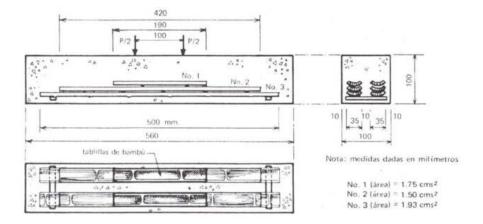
Viga (1) de hormigón reforzada con bambú. Fuente González Salcedo, 2001
